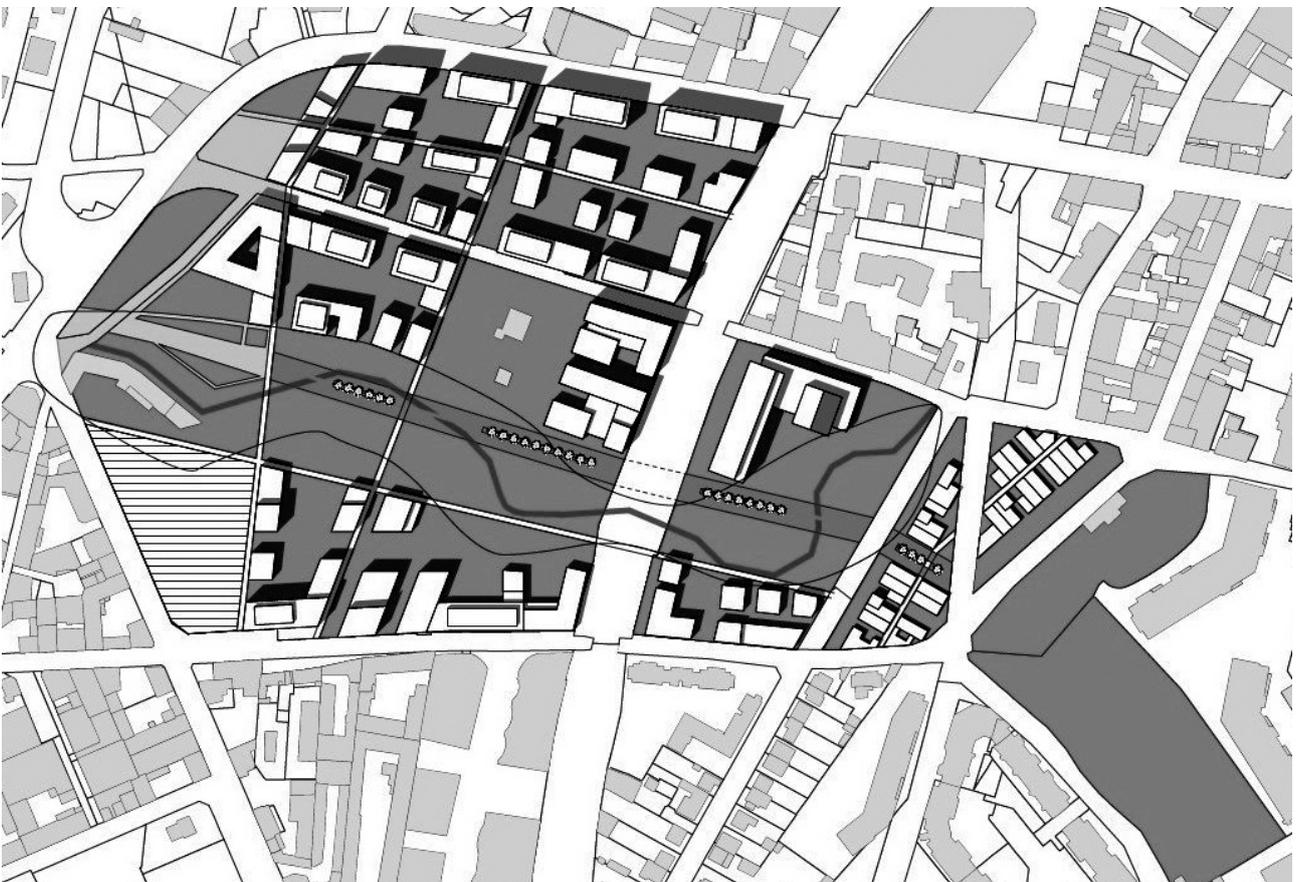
Plan de masse du projet du Ruisseau des Planches à Lyon (Garcias, Brun, Maléfant, CNRS, 2015)
